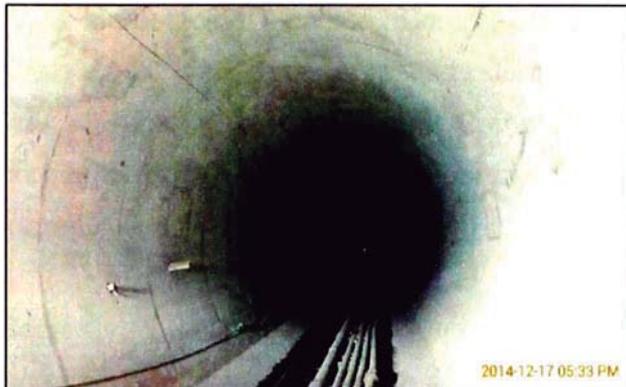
Vista del Túnel de Presión con Revestimiento de Concreto
